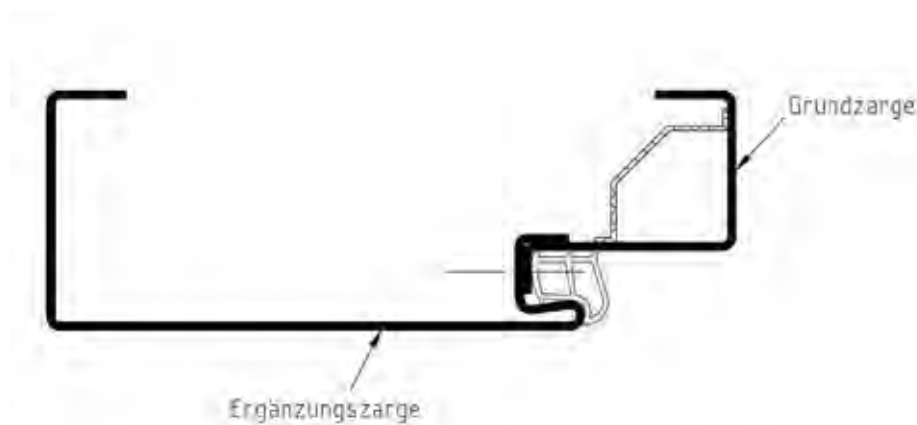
Zargenprofil – 2-schalige Stahlzarge
